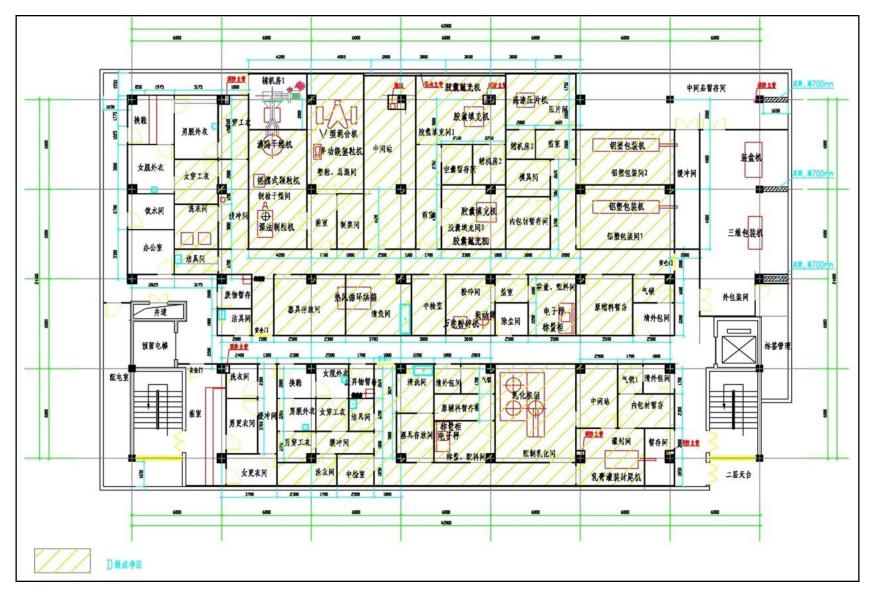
项目三楼固体、乳膏制剂车间总平面布置
